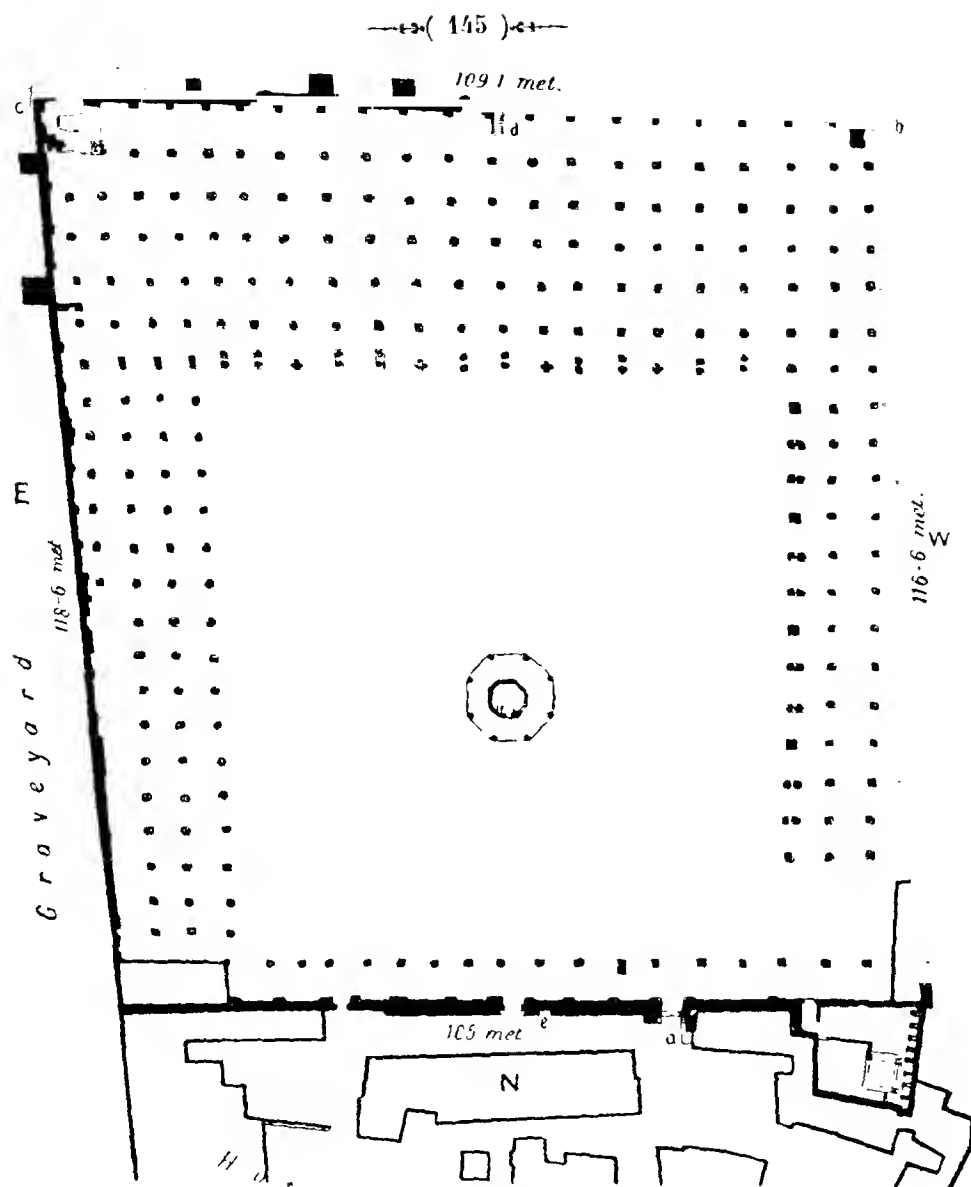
Plan du Ministère des Waqfs (1873).
